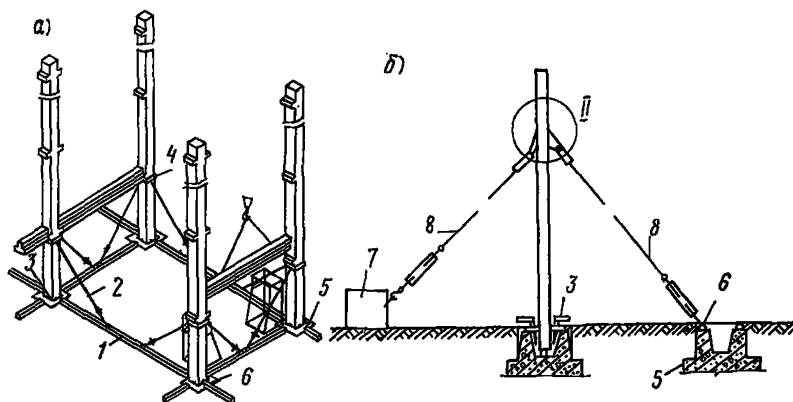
Установка колонн высотой свыше 12 м в стаканы фундаментов
